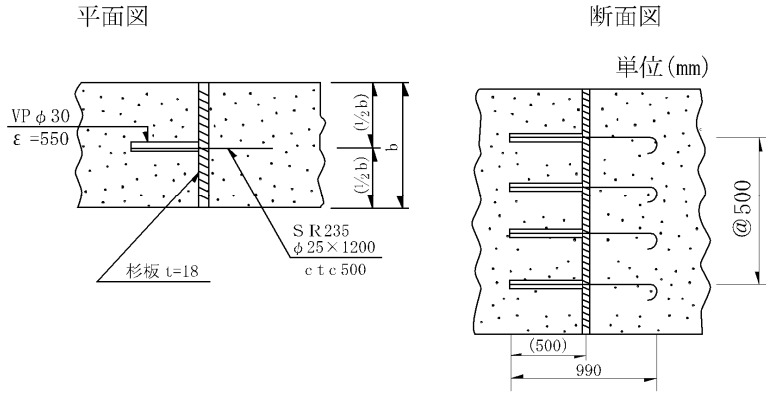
III-33 膨張目地の構造(無筋コンクリート擁壁)
